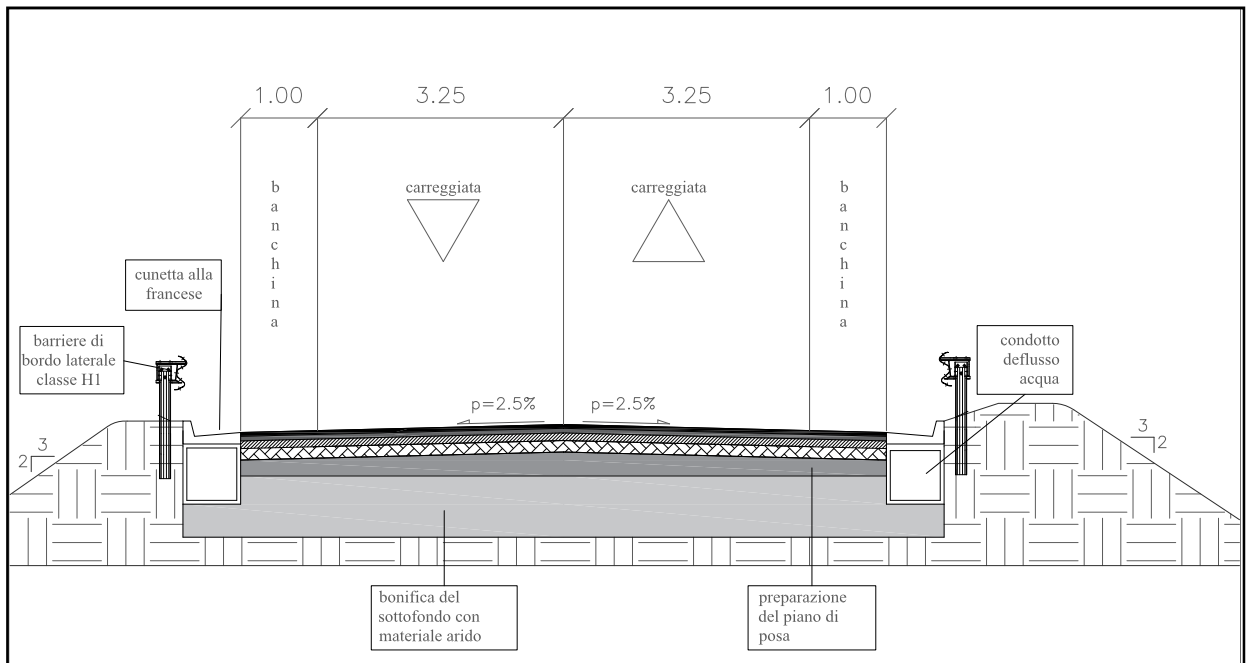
sezione tipo F1 via Porrione (scala 1:100)
